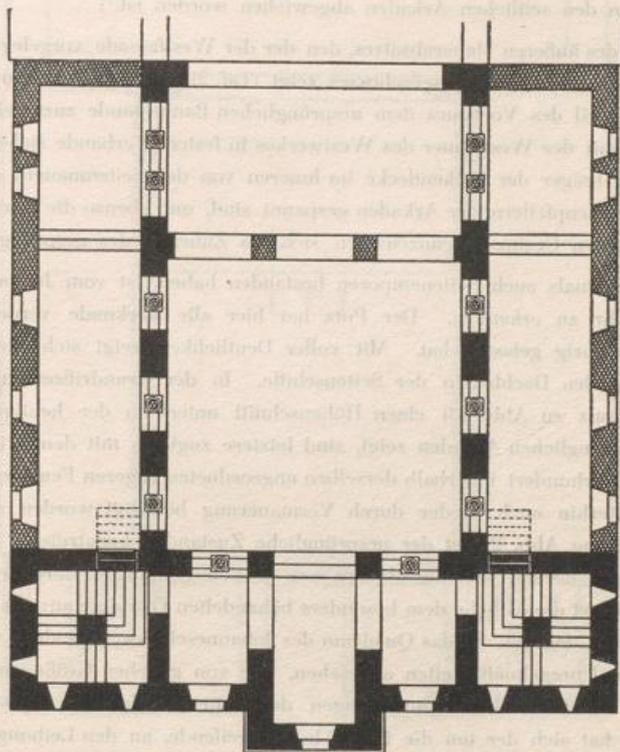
Grundriß-Rekonstruktion des ursprünglichen Emporengeschoßes (885)
